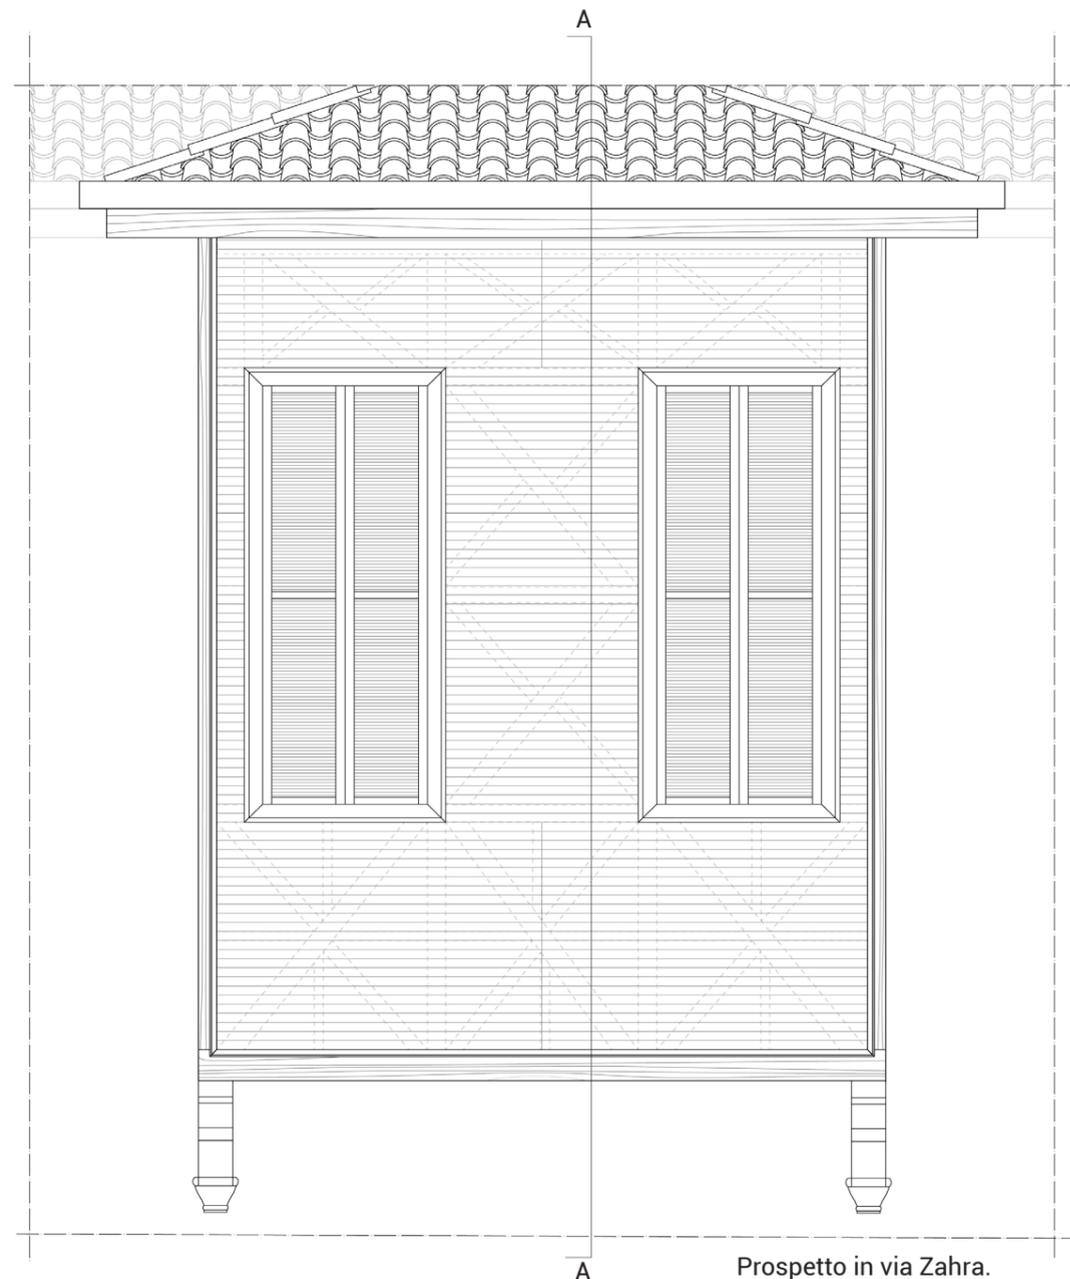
Ricostruzione congetturale della struttura di un bovindo, quartiere di Arabahmet.
